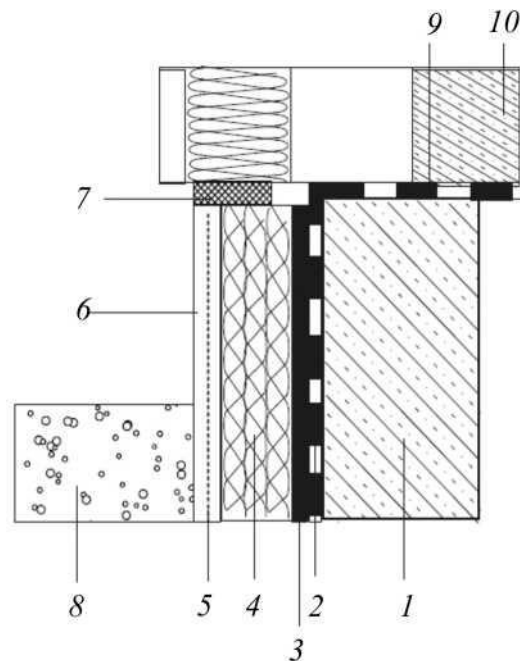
Приклад утеплення цоколя будівлі: 1 – фундамент;
